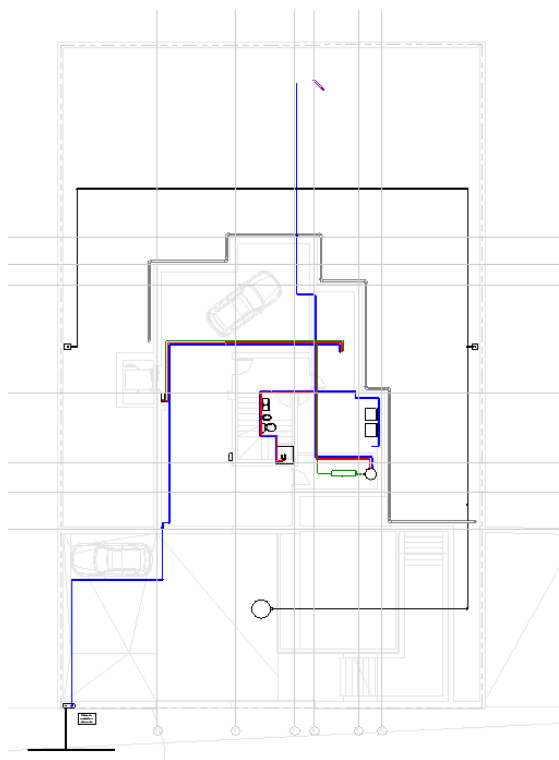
Planta de um piso com os elementos da rede predial de abastecimento de água.
